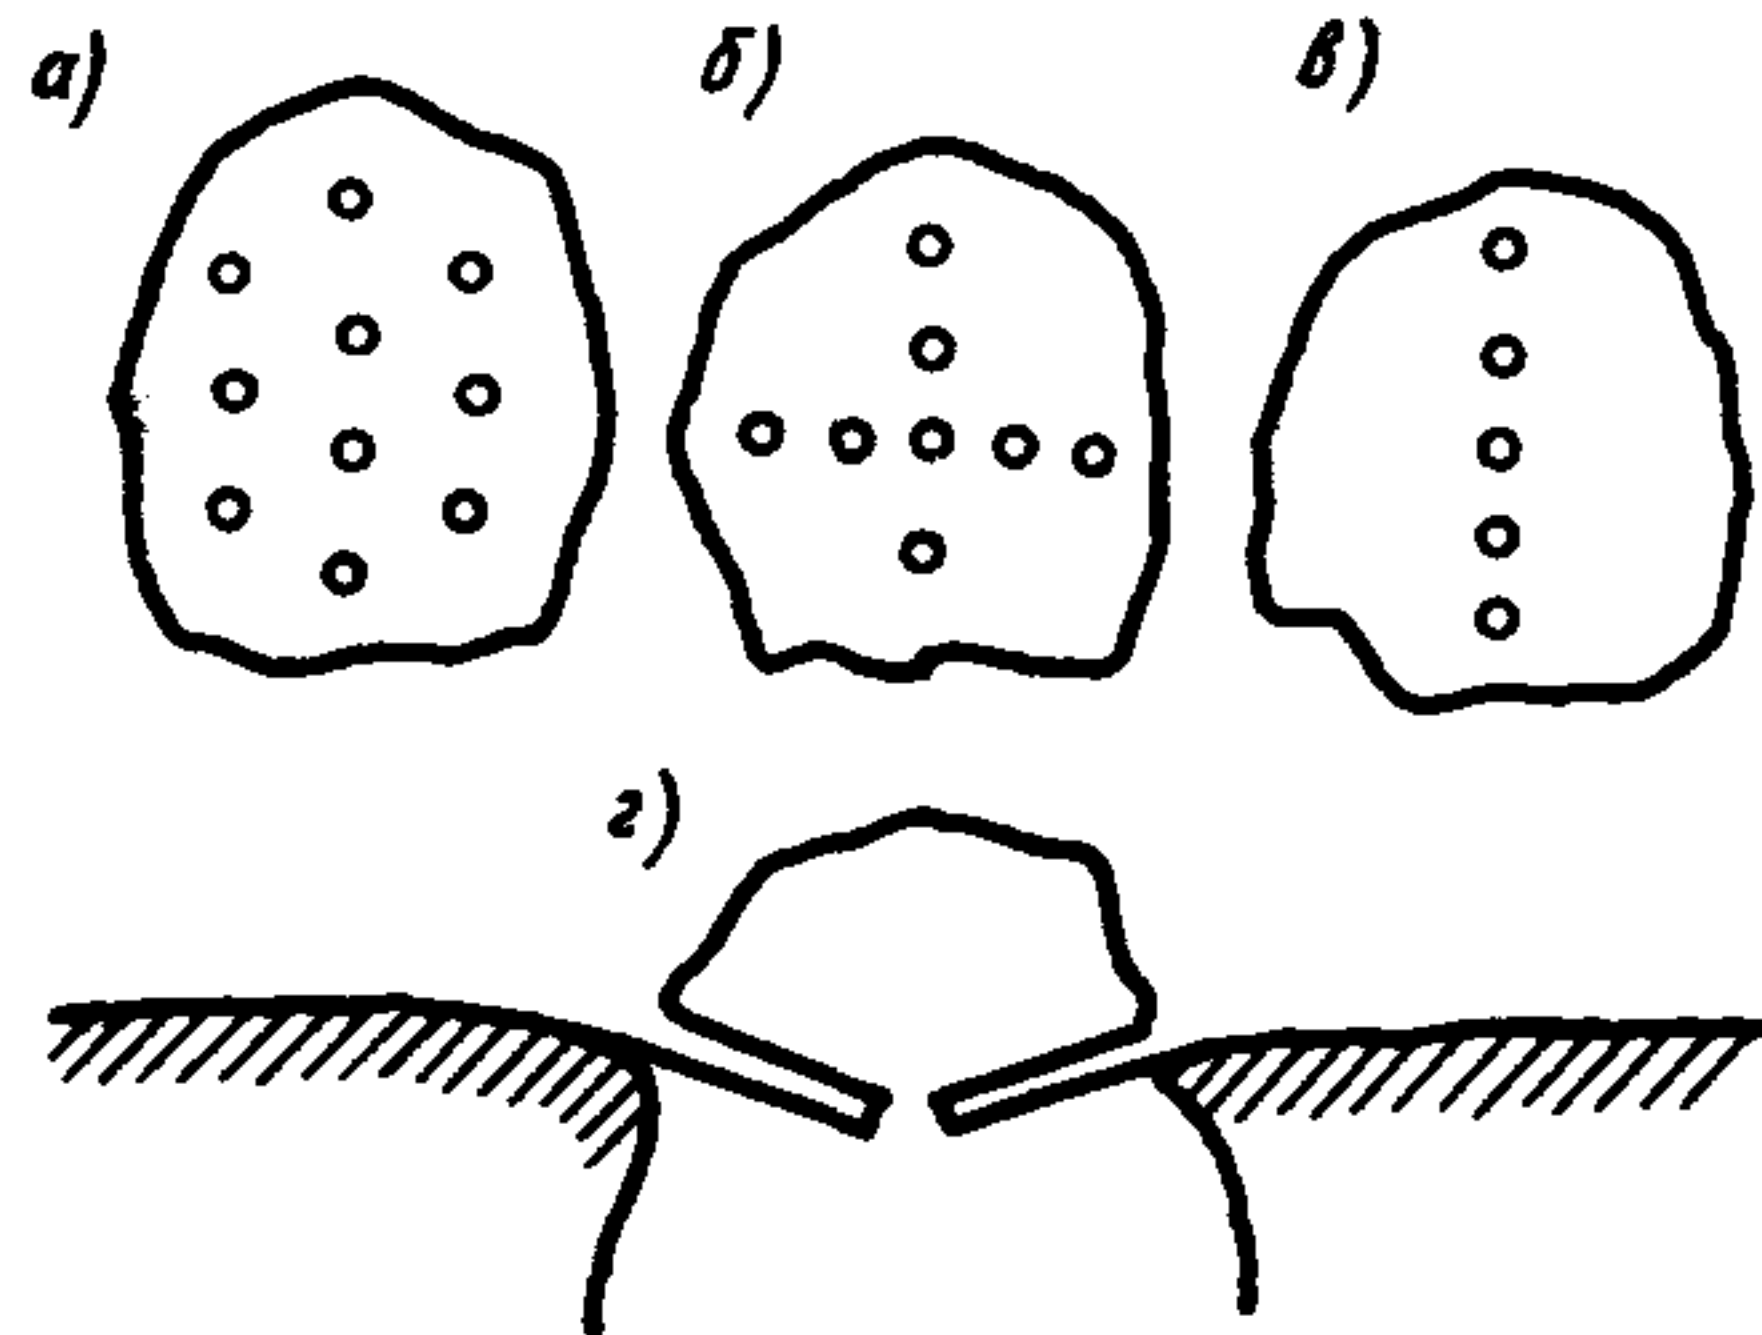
План расположения шпуров при разрушении негабаритов горных пород
